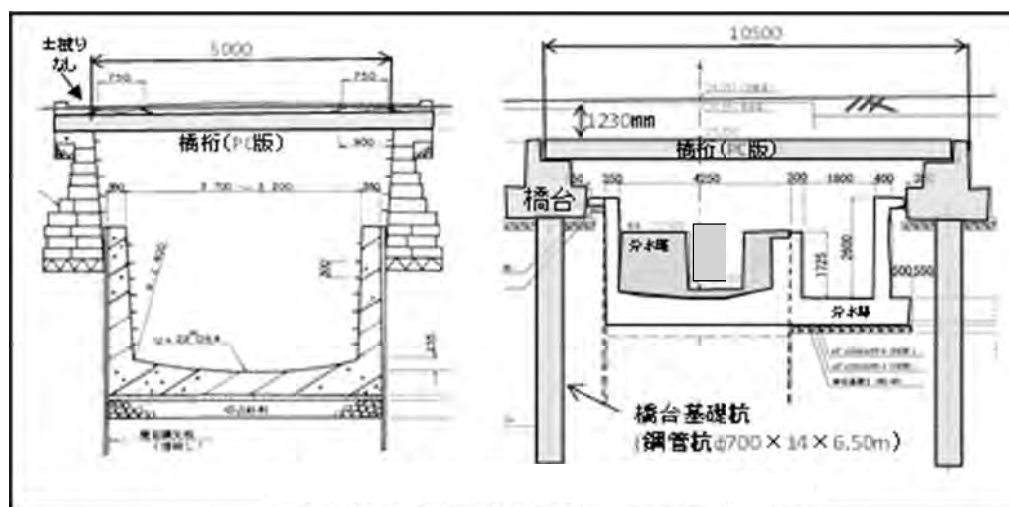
：谷端川上幹線断面図（左＝施工前 右＝施工後）
